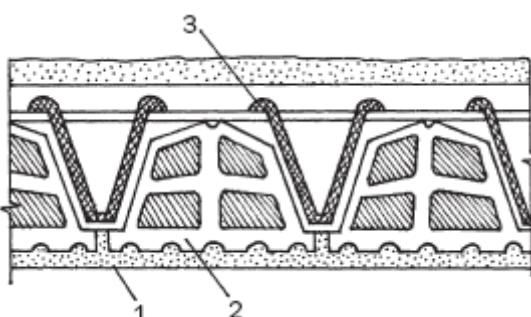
Перекрытия с вкладышами: 1 - штукатурка; 2 - керамический вкладыш; 3 - арматура ребра
